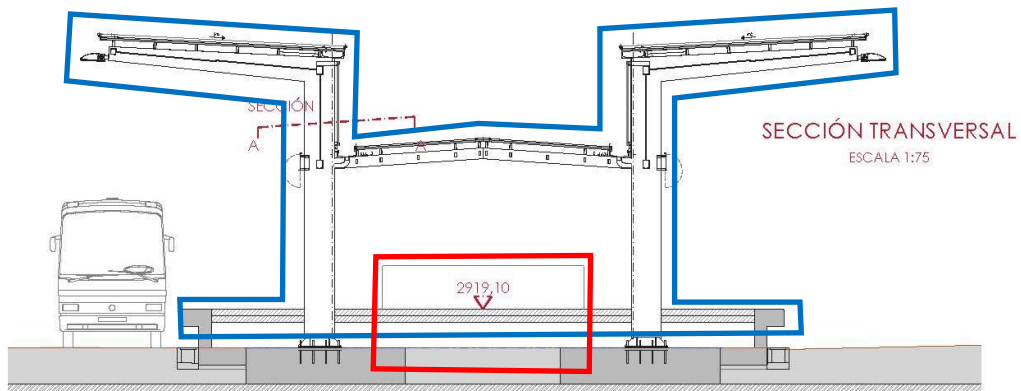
Sección transversal acceso 4 (rojo EPMMQ, azul EPMPQ).
